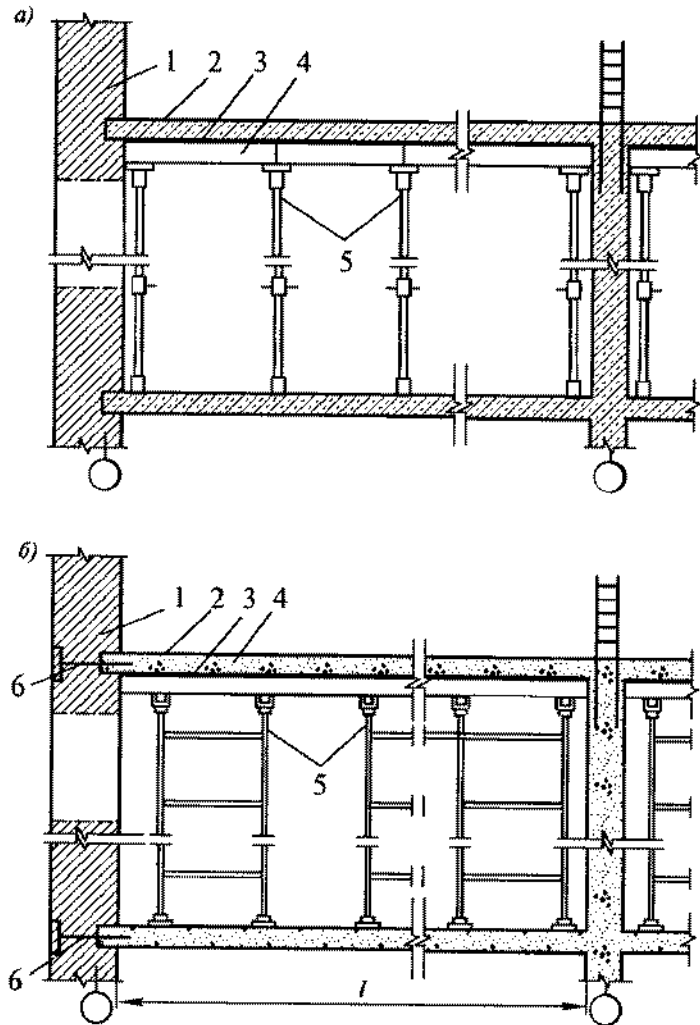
Схемы опалубочных систем для устройства балочных перекрытий:
